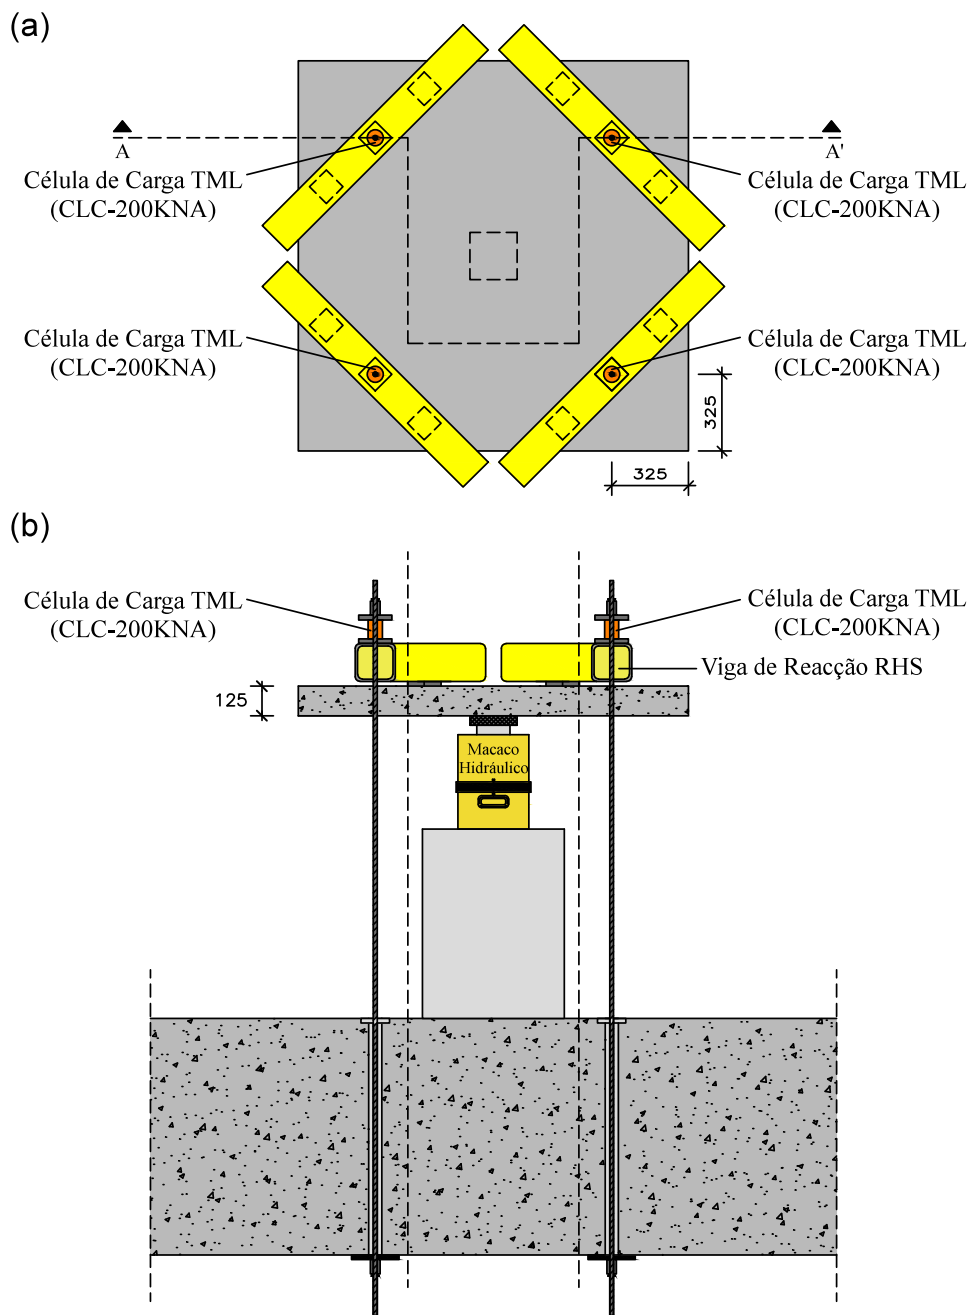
Localização em planta e em corte das células de carga, (a) planta e (b) corte A-A' (desenhos sem escala e dimensões em mm).
